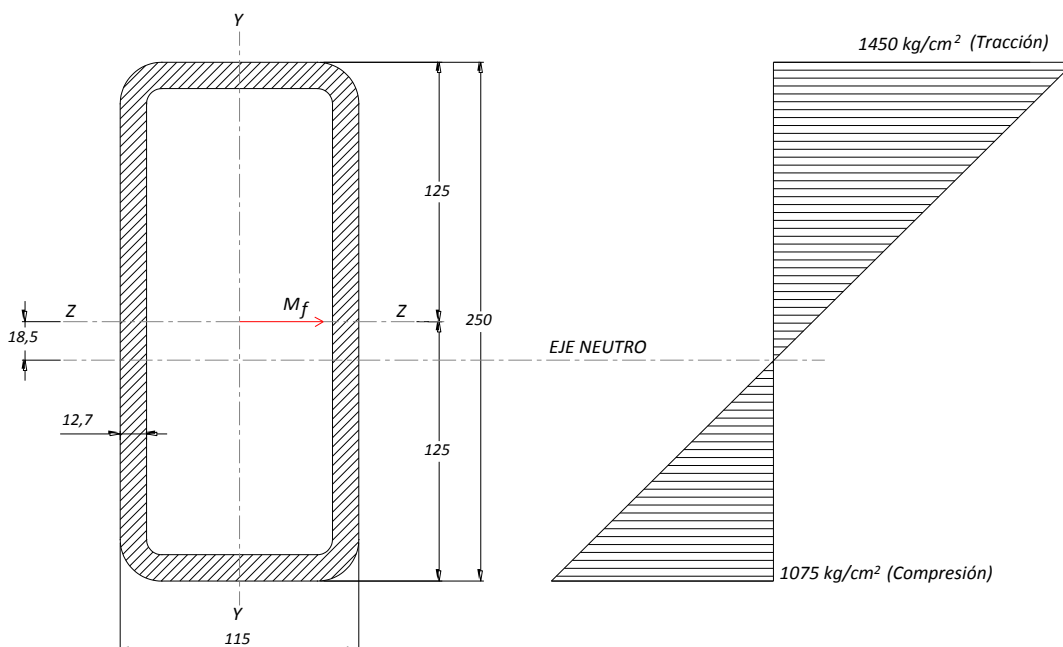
Sección de mayor sollicitación en la viga de la rampa. (Estado I).
